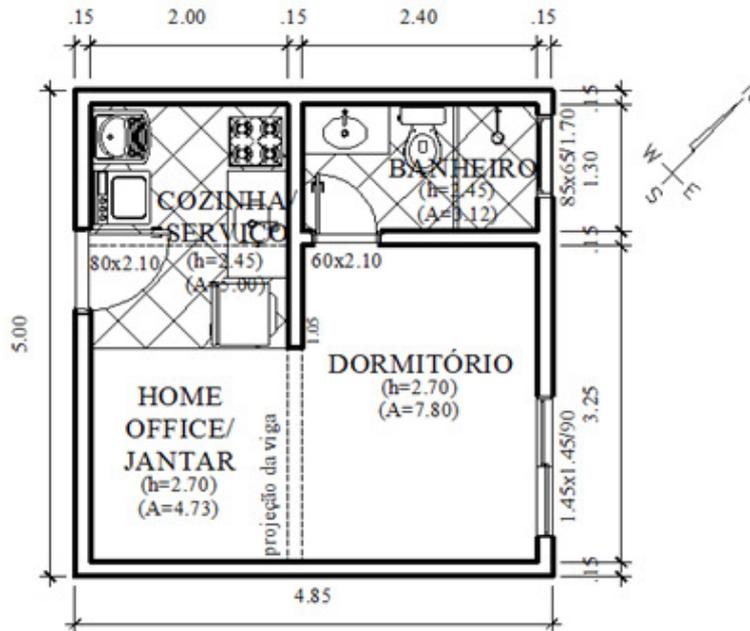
Planta baixa da habitação compacta do estudo de caso.
